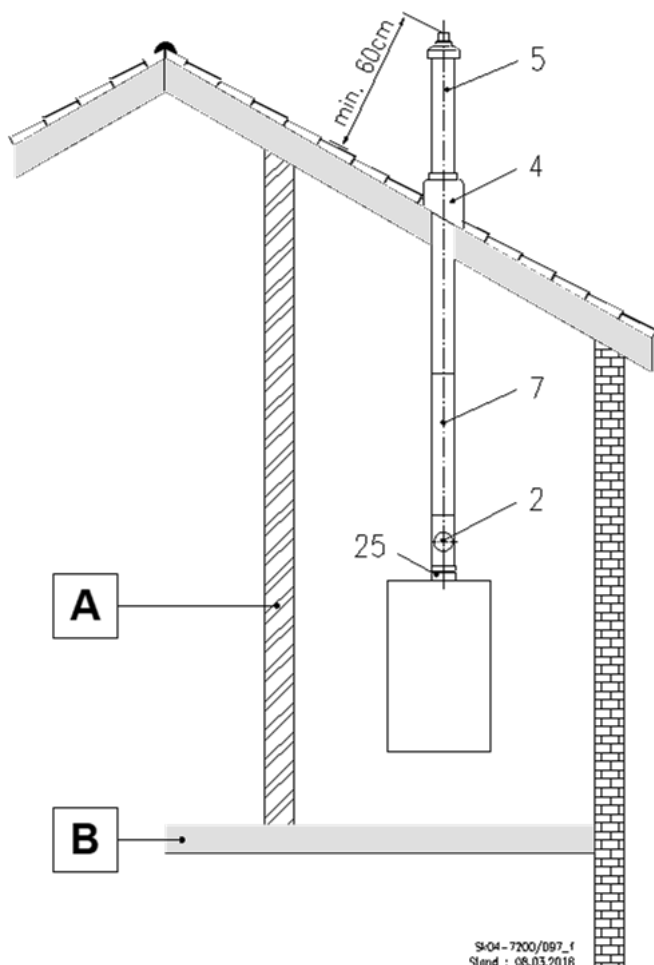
C<sub>33x</sub> Dachheizzentrale mit der Durchführung senkrecht durch ein Schrägdach
